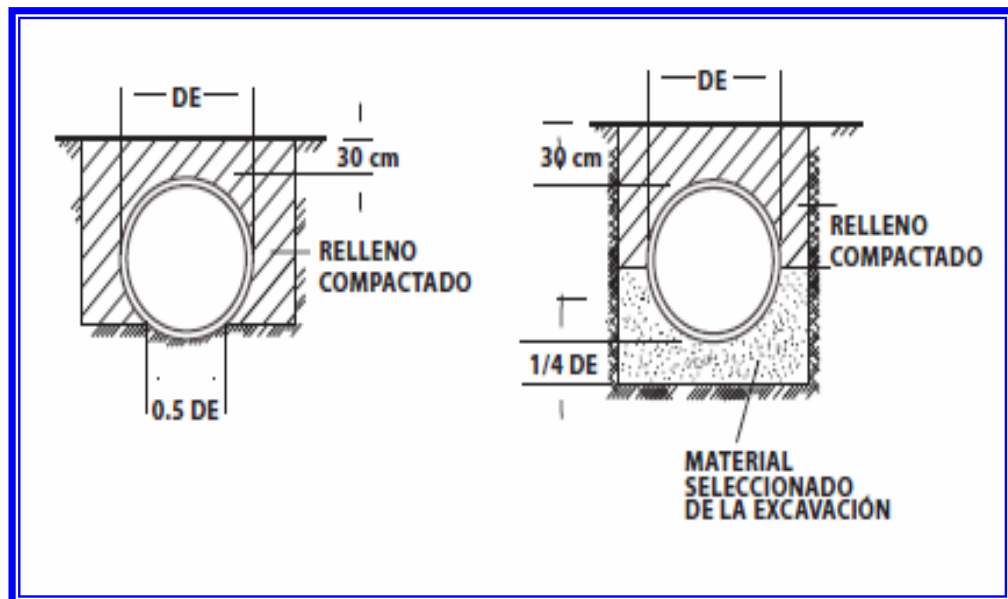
Apoyos tipo B y tipo C, de izquierda a derecha respectivamente, recomendados para colocación de tuberías PVC. Fuente: Catálogo de especificaciones técnicas Tubrica
